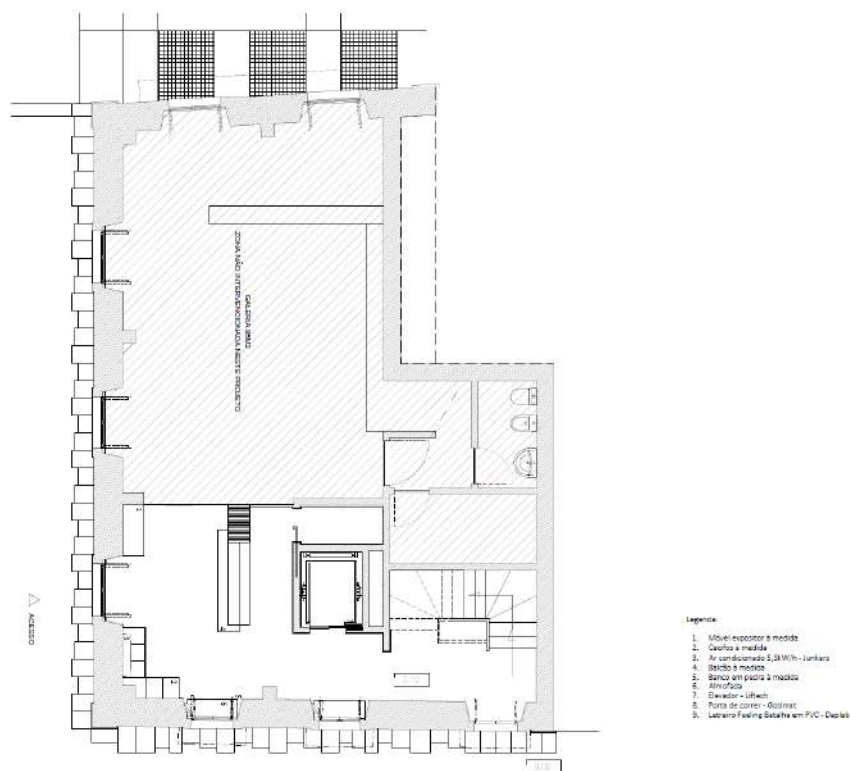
Planta de Mobiliário e Equipamento - Piso 0
